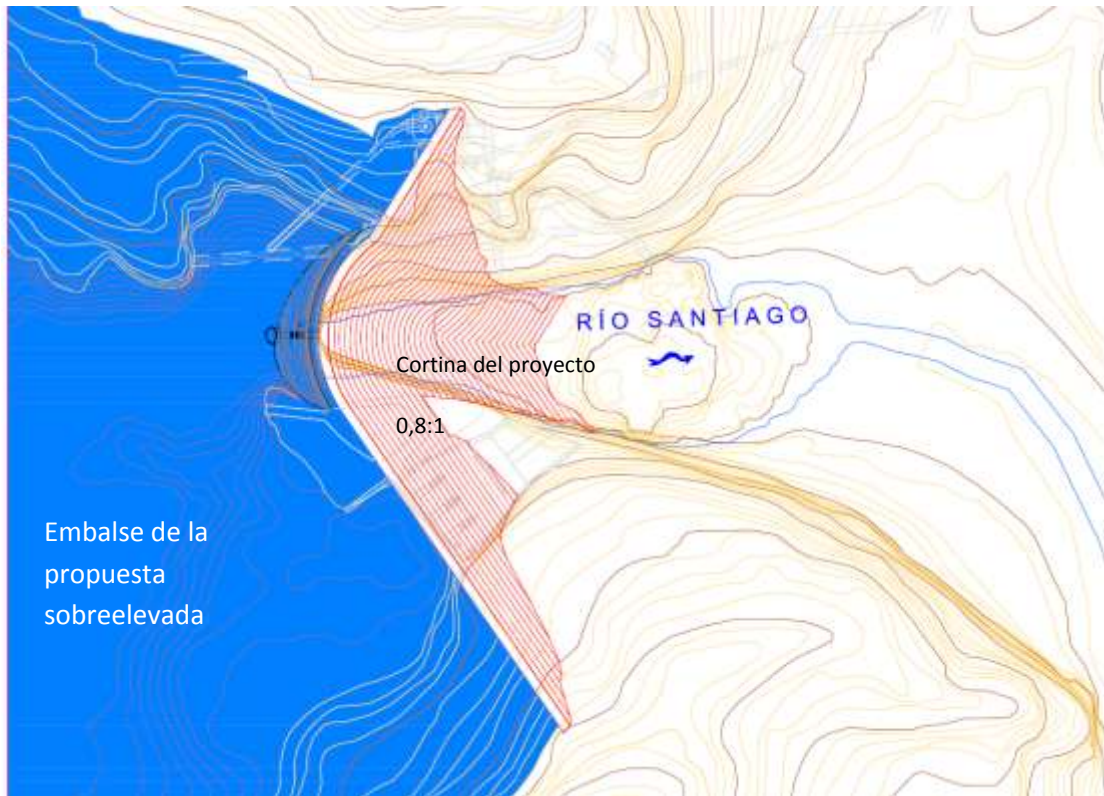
Planta de la cortina de CCR propuesta para sobreelevar Santa Rosa.
